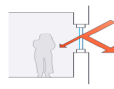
Acristalamiento de fachada oeste. Elaboración propia.
